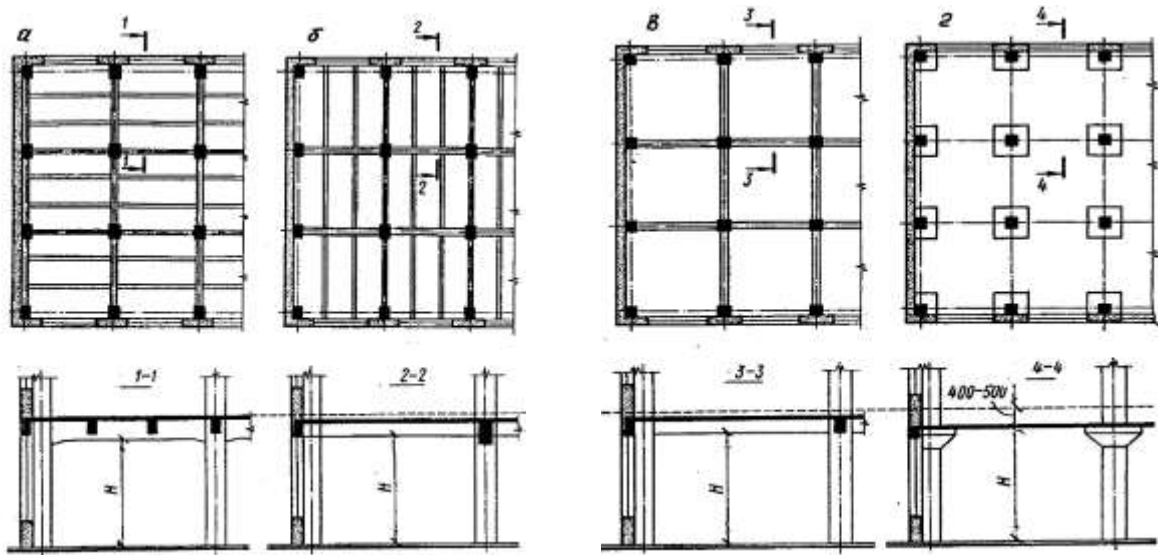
Схеми монолітних залізобетонних каркасів: а — з поперечними головними рамами; б — з поздовжніми головними рамами; в — з плитами спертими по контуру; г — з безбалковими перекриттями
